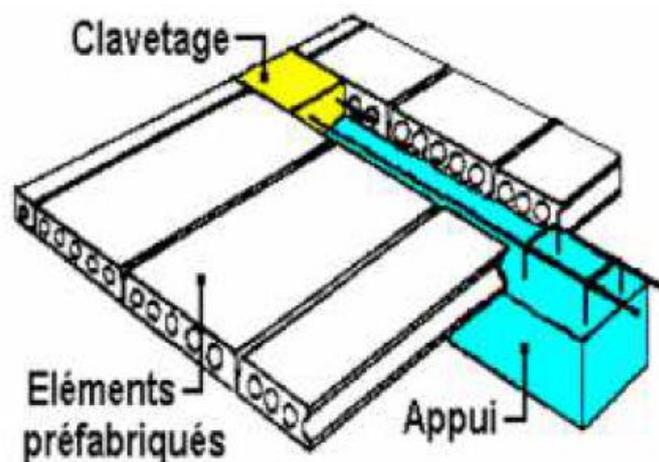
exemple de clavetage d'un ouvrage en béton armé
